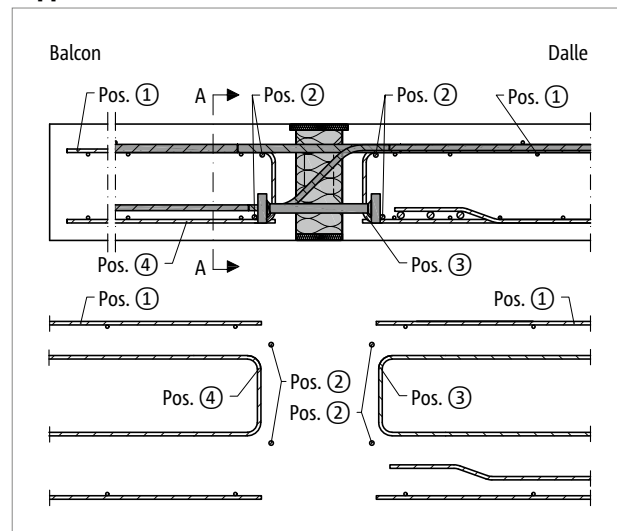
Schöck Isokorb® T Type K-M12 : Renforcement sur site pour support indirect
